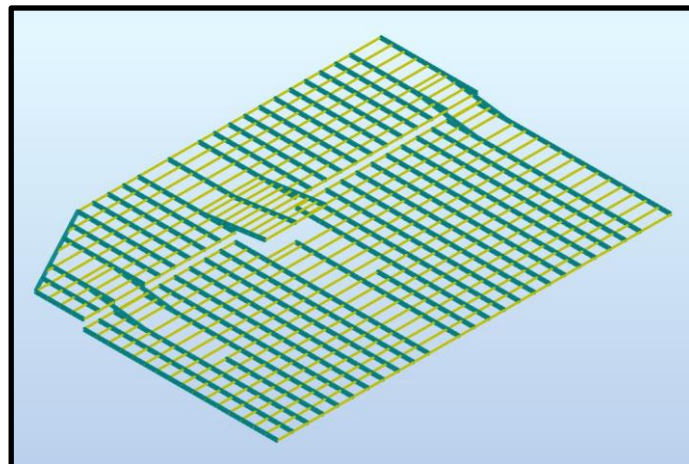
Disposition des solives et des poutres principales [Premier bloc (parking)]
